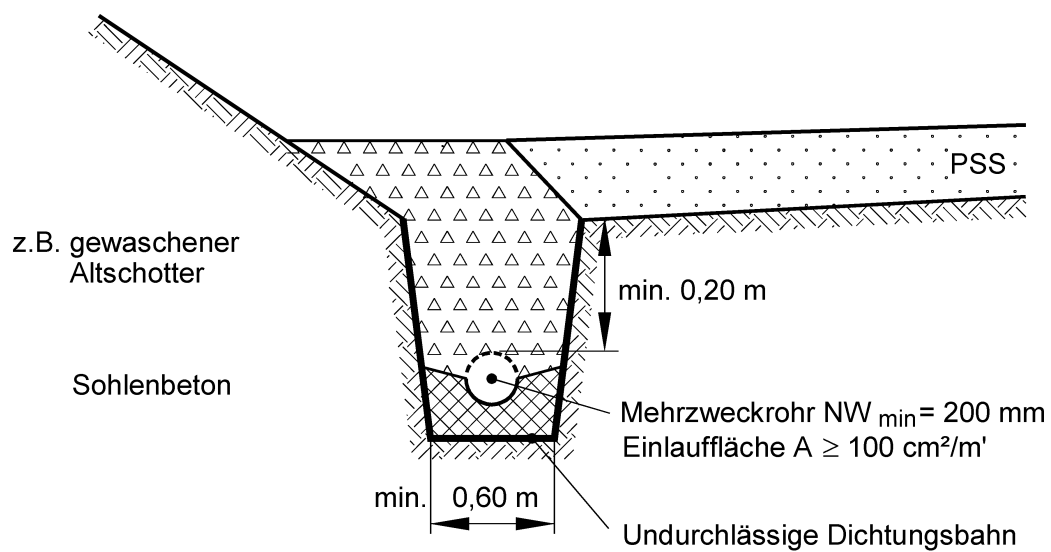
A812 : Drainage de type 4b, dérivation avec étanchéité du fossé (conservation).
